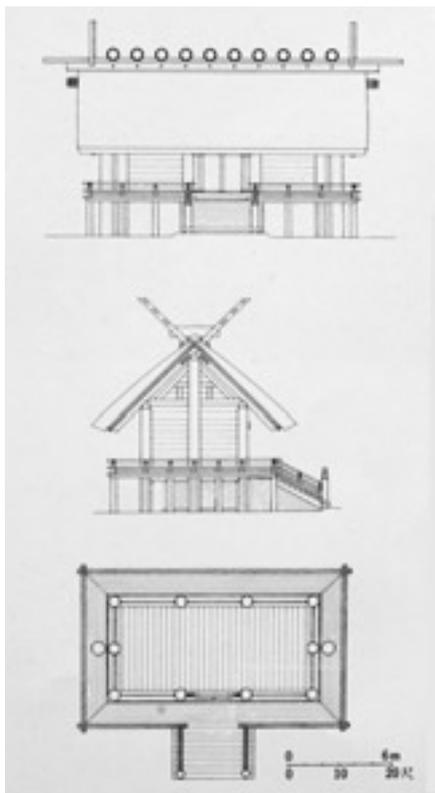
伊勢神宮内宮正殿 正面図 側面図 平面図
